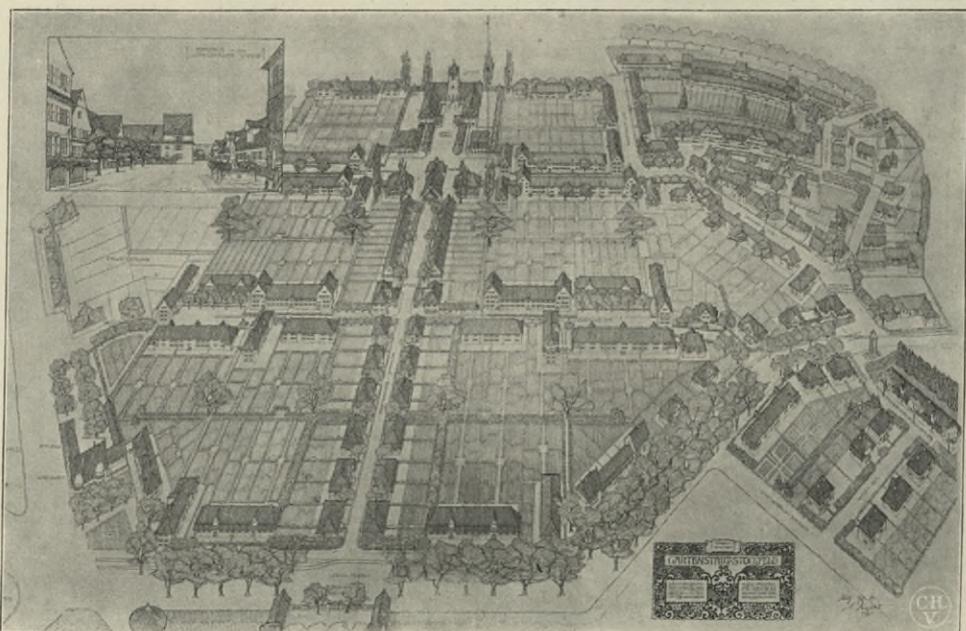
Gartenstadt Stockfeld bei Straßburg i. E. Gesamtbild des ersten Bauteils. Architekt E. Zimmerle
